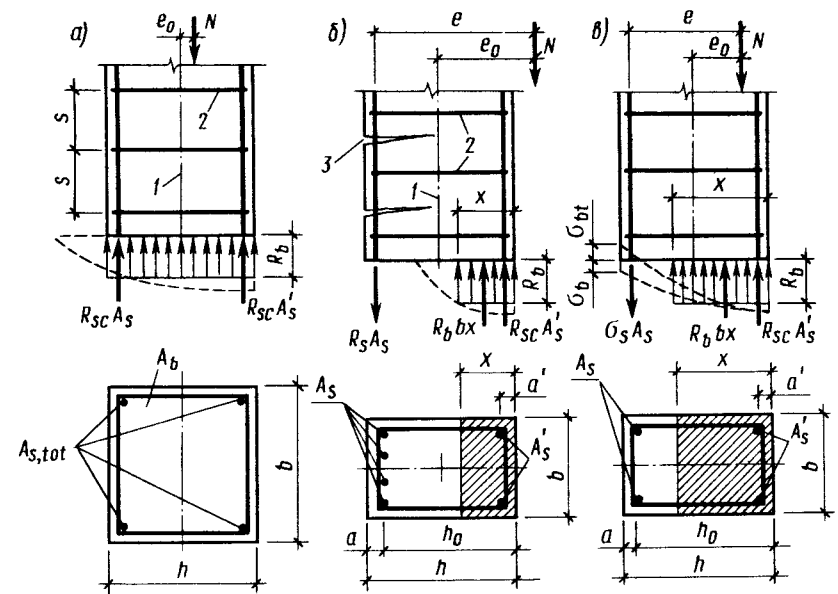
Схемы расчетных усилий в сечениях сжатых железобетонных элементов со случайным (а) и расчетным (б, в) эксцентриситетами
